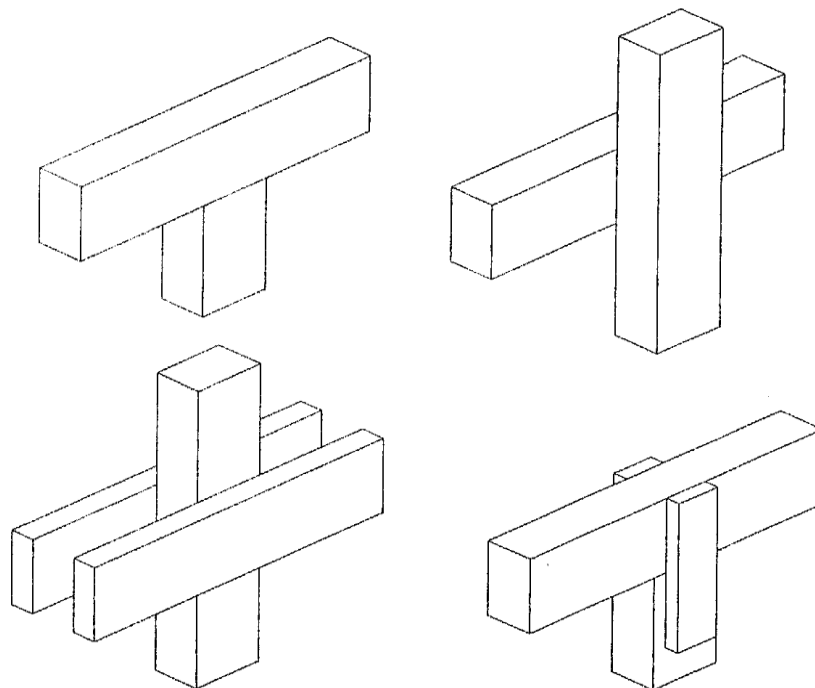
Pormenor de ligações viga-pilar por justaposição [Mendes, 1994]
